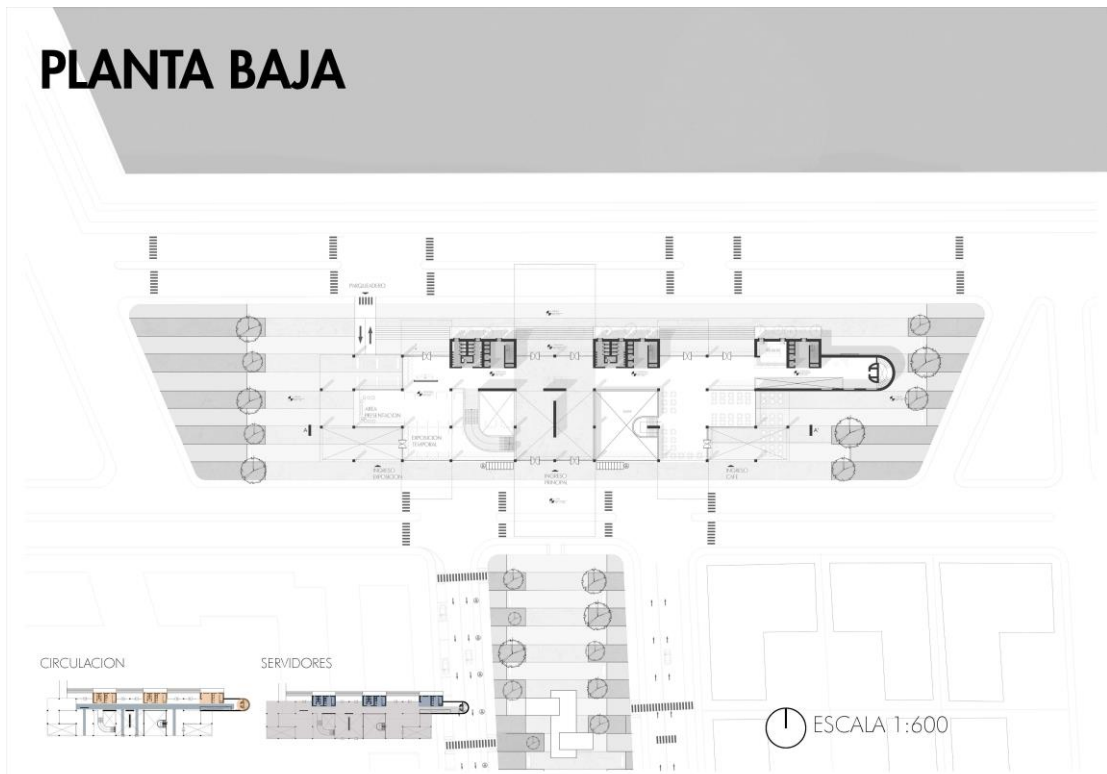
Planta Baja Nivel -0.60m Fuente: Autor
